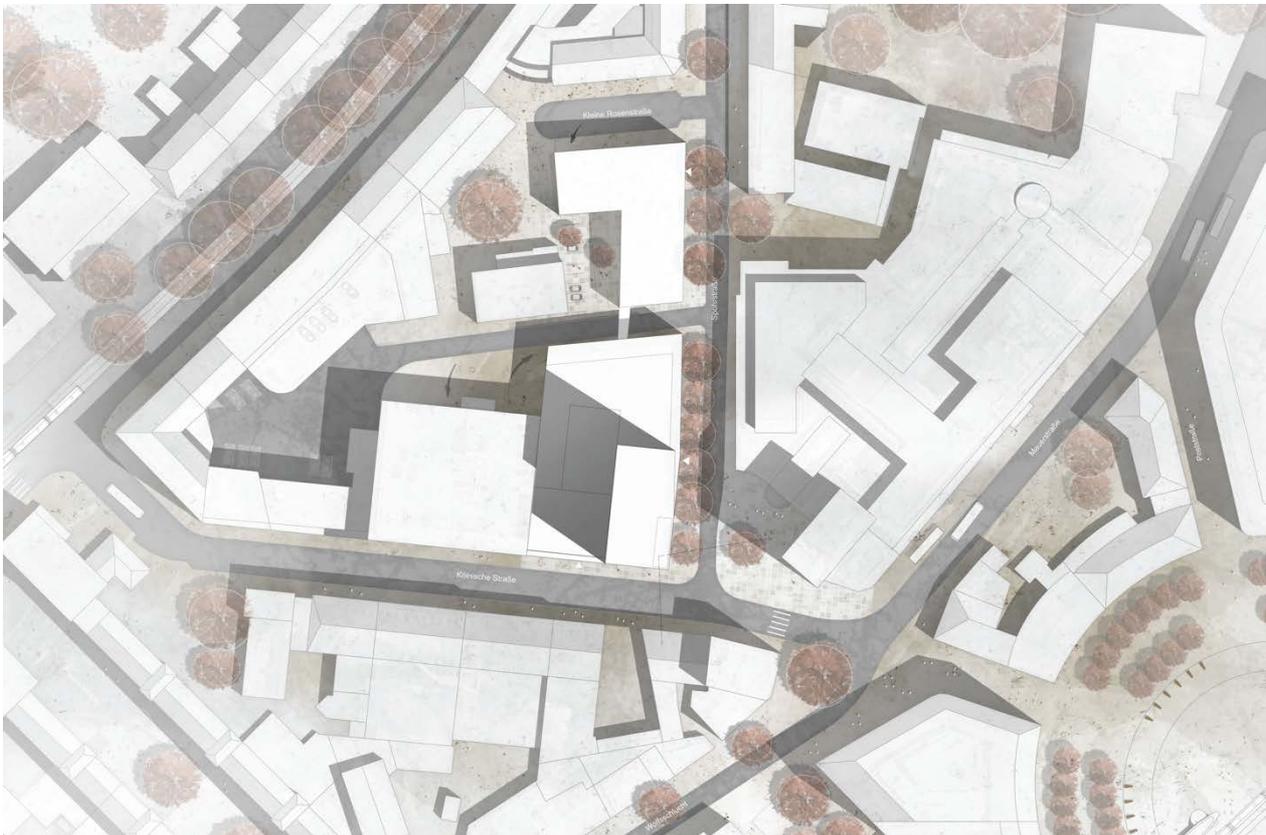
Lageplan der prämierten Wettbewerbsarbeit, Darstellung ohne Maßstab (Quelle: ATELIER 30 Architekten GmbH, Kassel)
